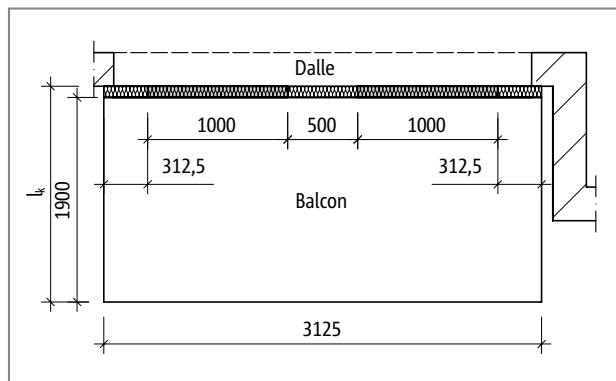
Schöck Isokorb® T Type K-E, K-T : Système statique, plan de base
